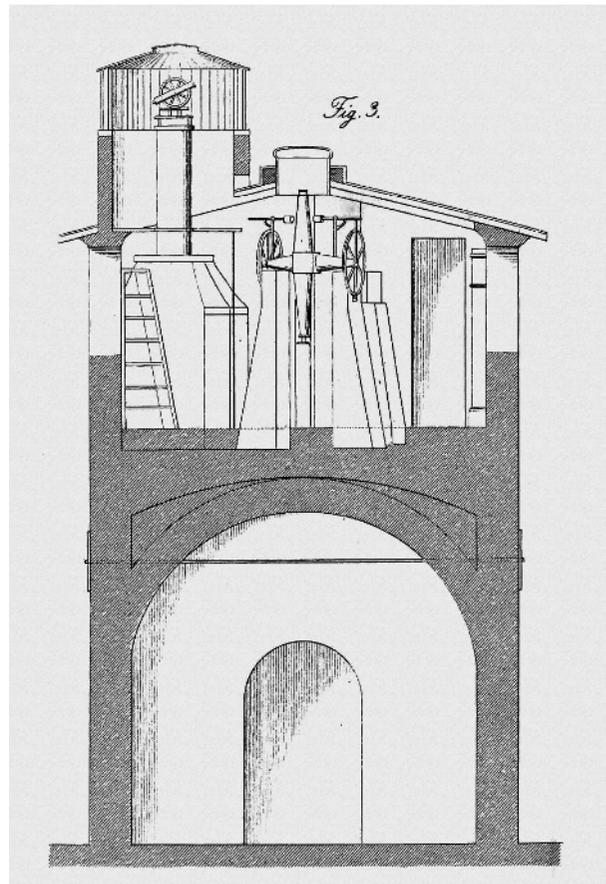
La disposizione degli strumenti ripristinati da Secchi nella Torre Calandrelli. (ANGELO SECCHI-AS 1850)
